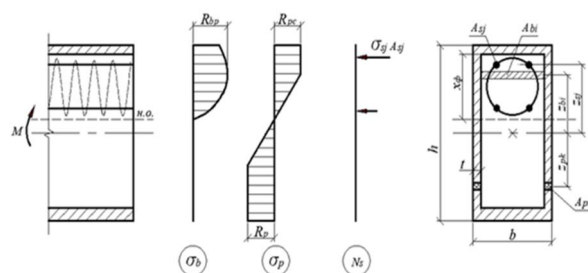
Схема усилий и эпюры напряжений в нормальном сечении балки
